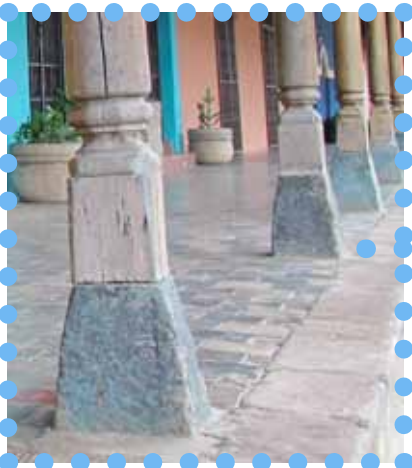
Photo et croquis de la pierre d'appuis (fondations) du poteau : déconnection du sol (barrière capillaire, pose du poteau par tenon - mortaise, tolère les mouvements en cas de séisme (source : photographie personnelle / élaboration propre)
